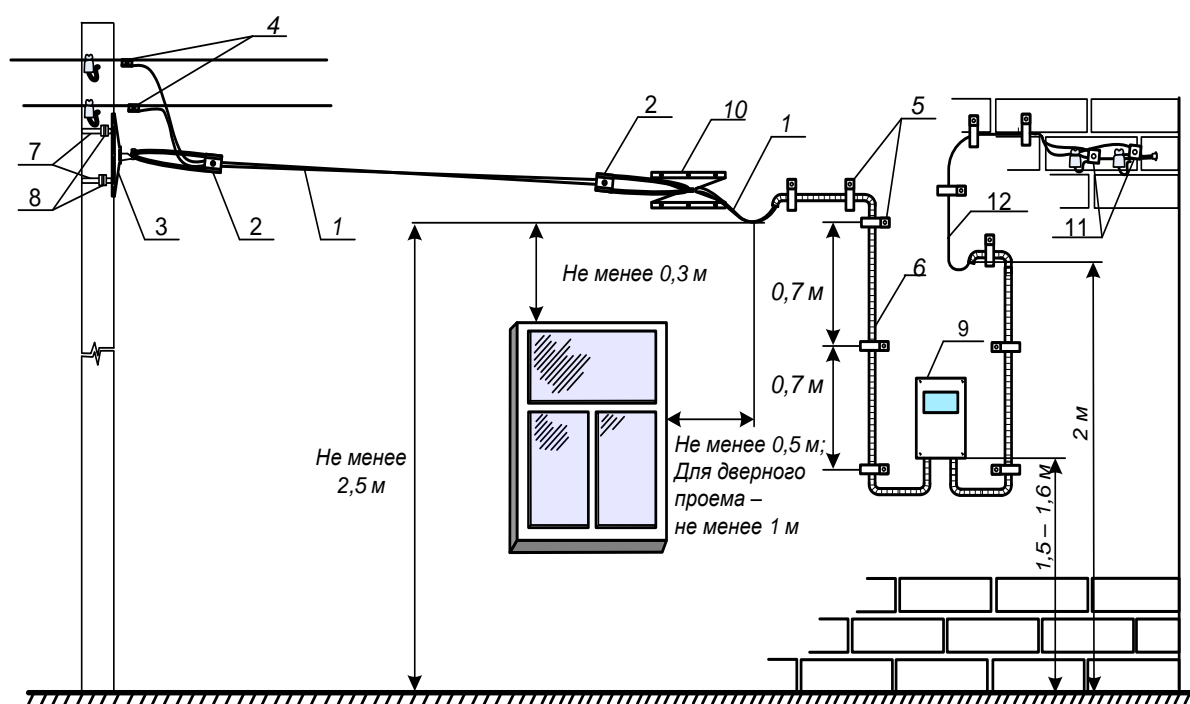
Ввод в здания от ВЛ 0,4 кВ с изолированными проводами при установке учета на фасаде здания
